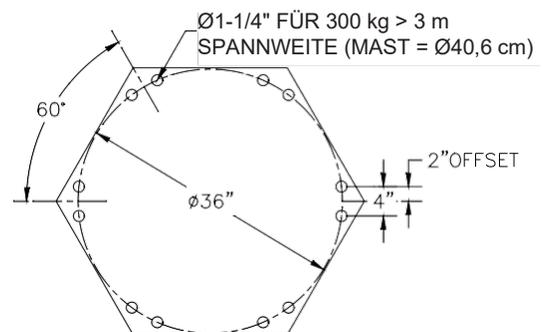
E. Sockelbolzenmuster mit 12 Bolzen.
